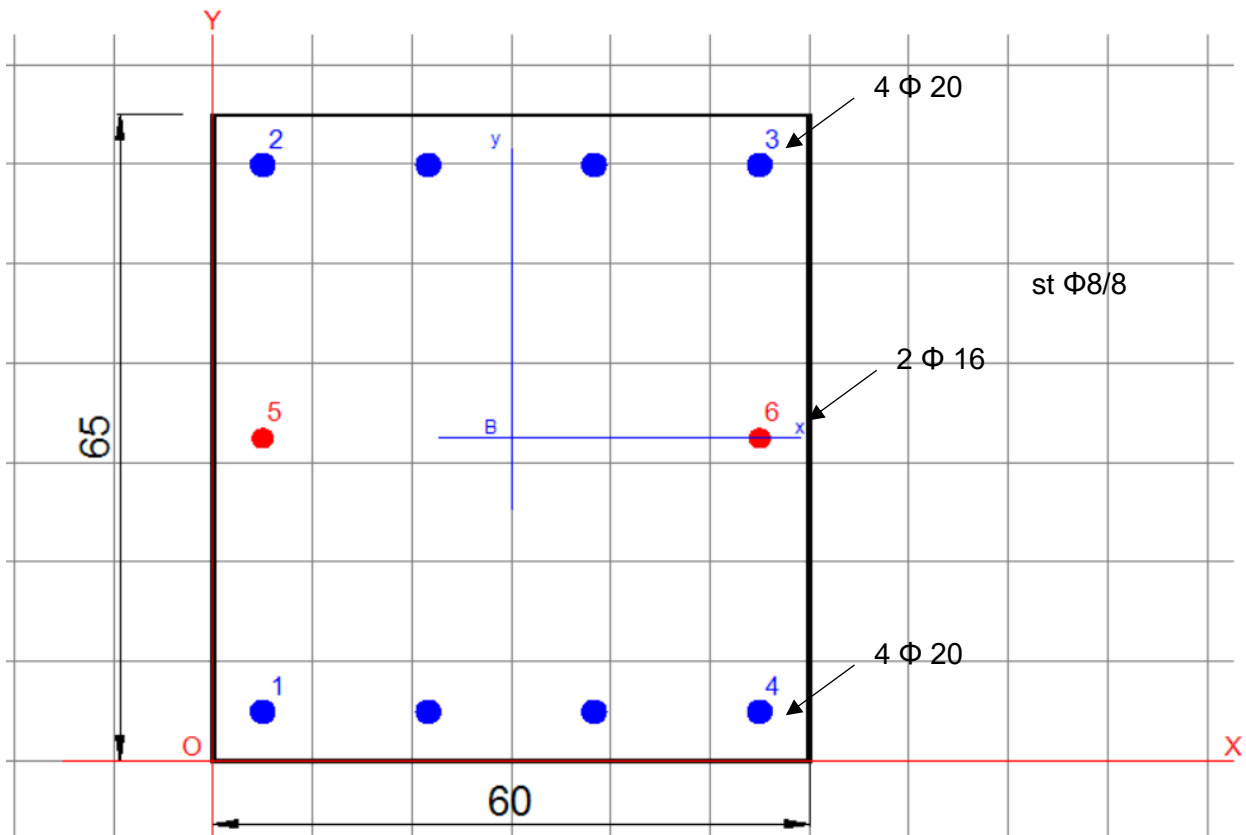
Tipologico ferri di armatura travi principali di fondazione
